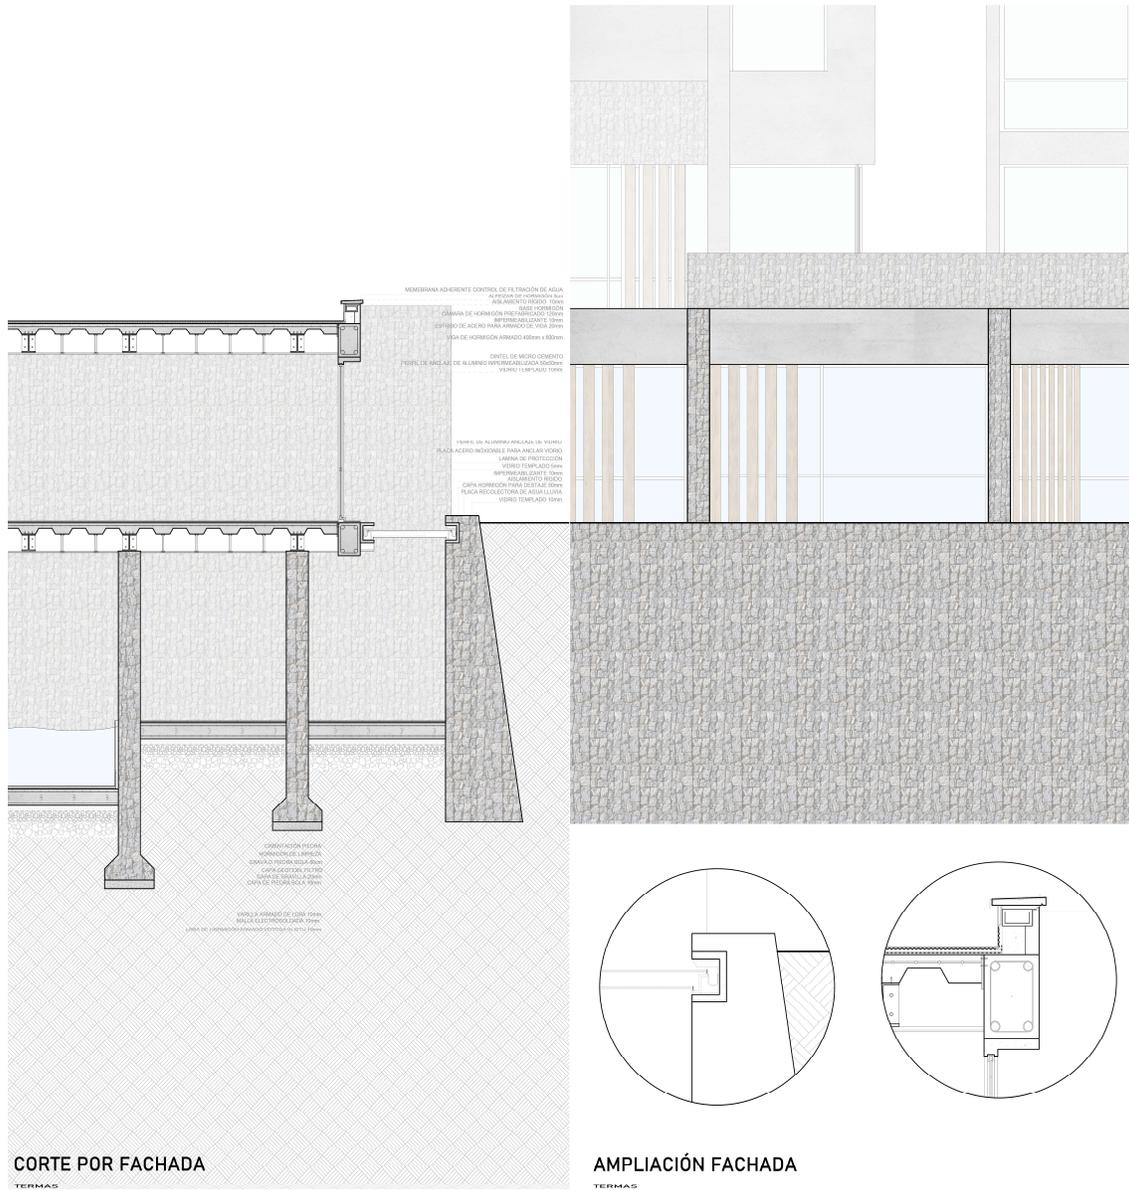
Corte por Fachada 3 / Resolución Constructiva. Elaboración propia
